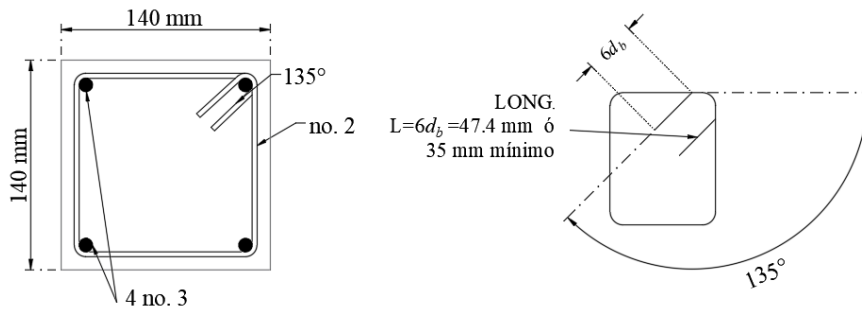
Detalle de armado longitudinal y transversal de castillos para el edificio Roma Sur.
